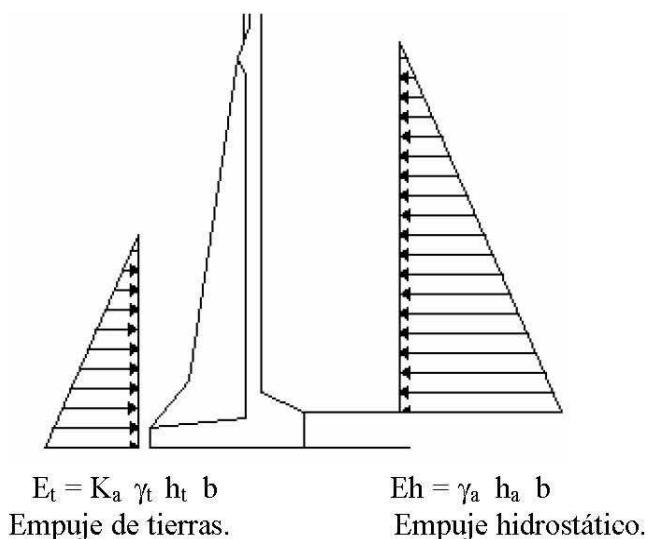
Cargas exteriores actuantes sobre el elemento modular.
